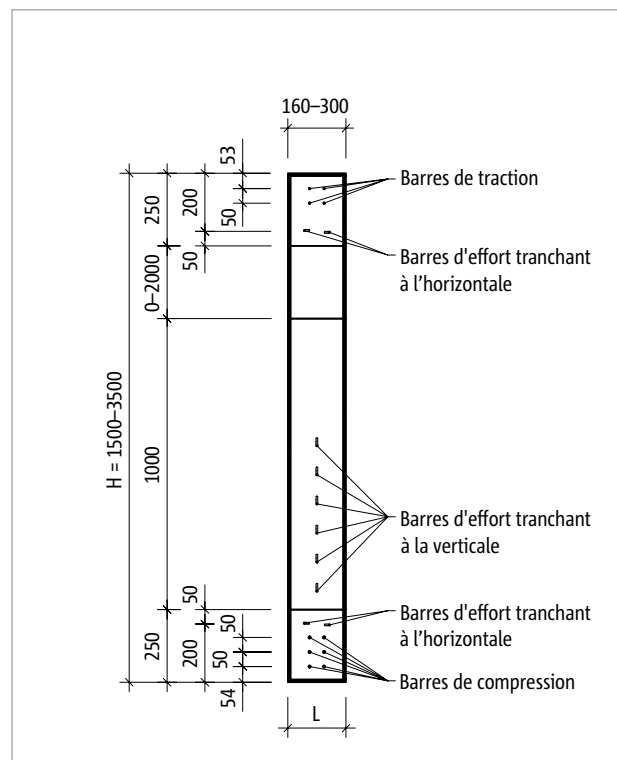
Schöck Isokorb® T type W-M1-R90 : vue du produit ; plaques coupe-feu sur tout le pourtour
